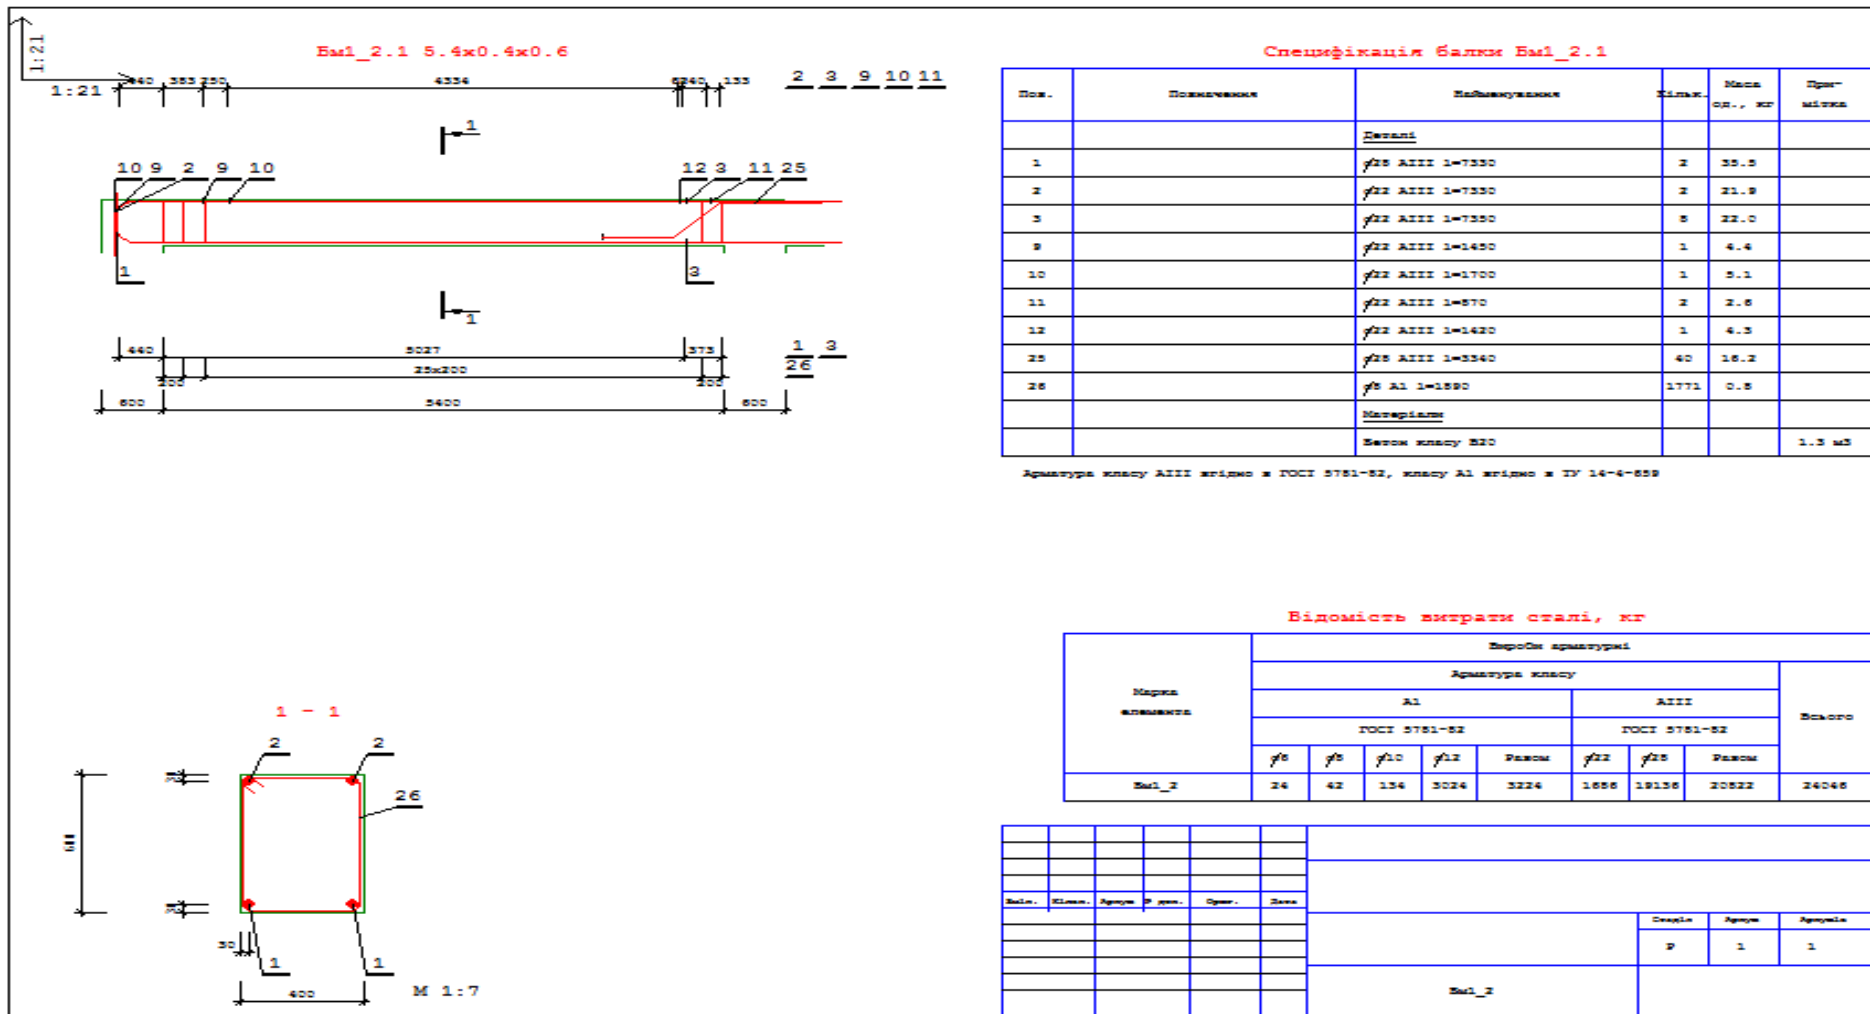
Варіант балочно - плитного перекриття. Балка Б1-2. Креслення робочого проекту.
